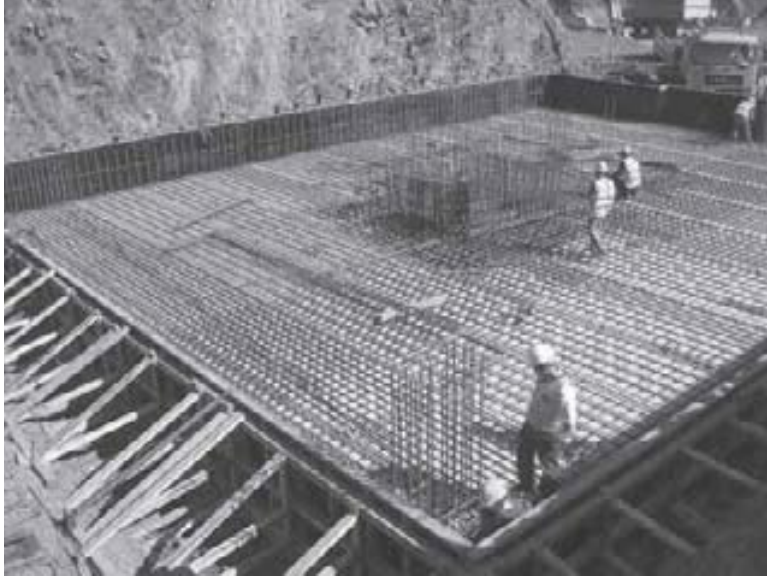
Losa de cimentación en construcción (Cortesía de Braja M. Das, Henderson, Nevada)
